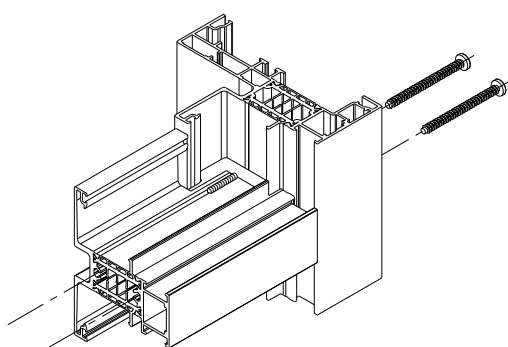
DETAILS ETANCHEITE DANS ASSEMBLAGE TRAVERSES / MENEaux
